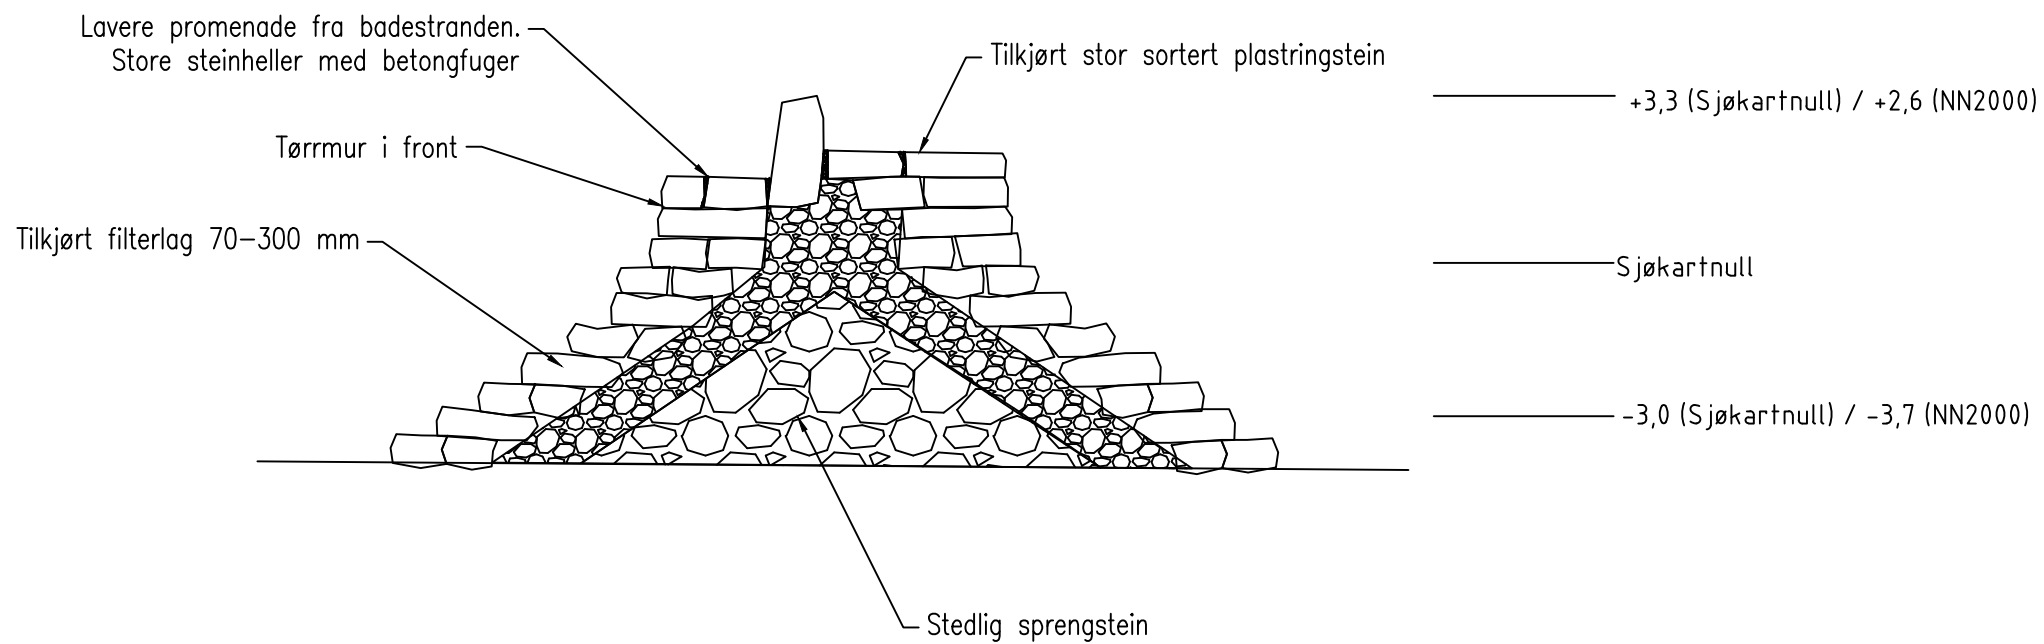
Plan molo med fyllingsfot ved sjøbunn angitt.
